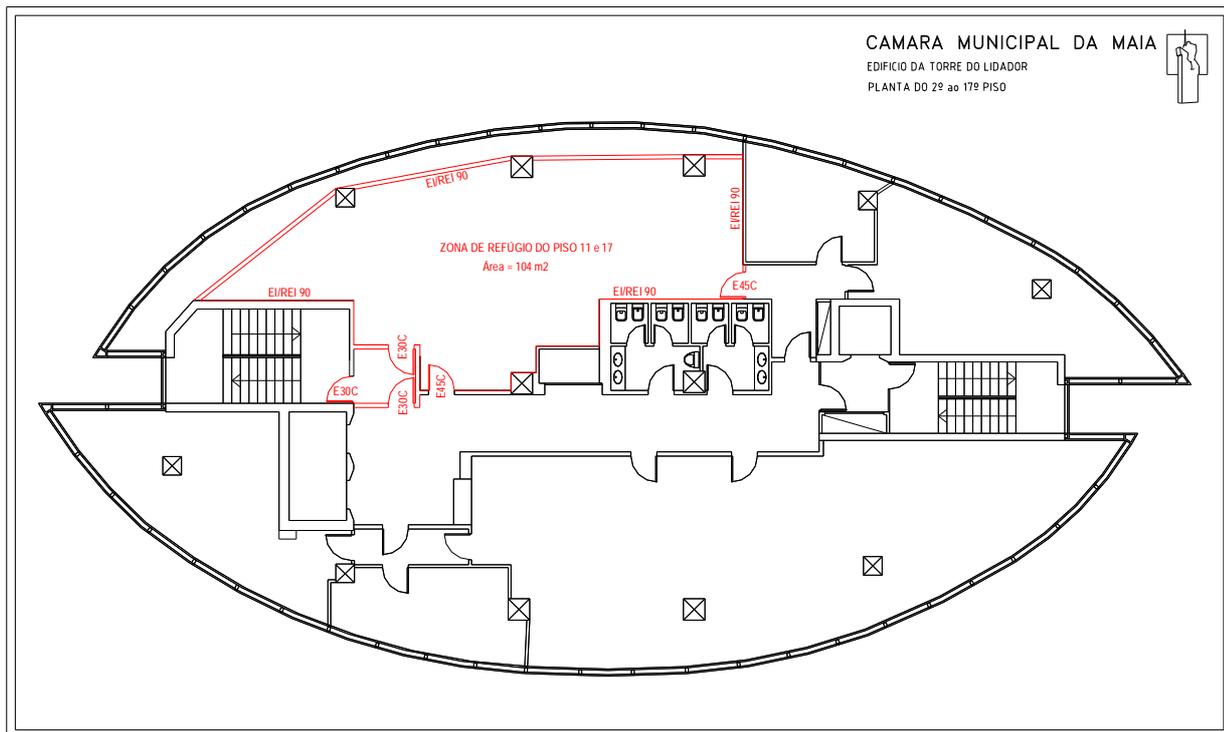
Planta das zonas de refúgio dos pisos 11 e 17.
